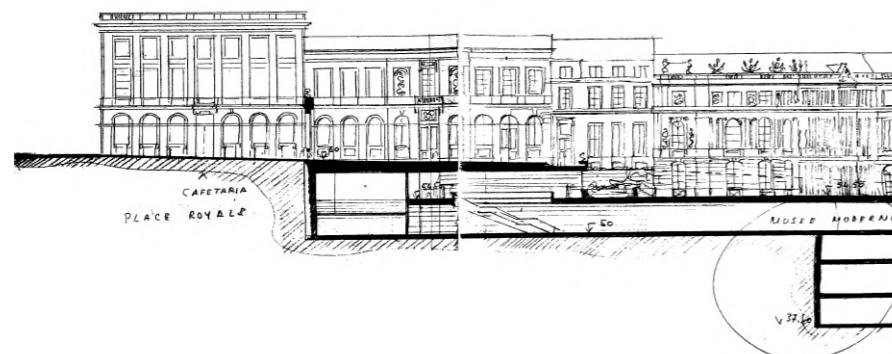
Coupe longitudinale du passage souterrain sous la rue du Musée, ébauche du musée camouflé.
